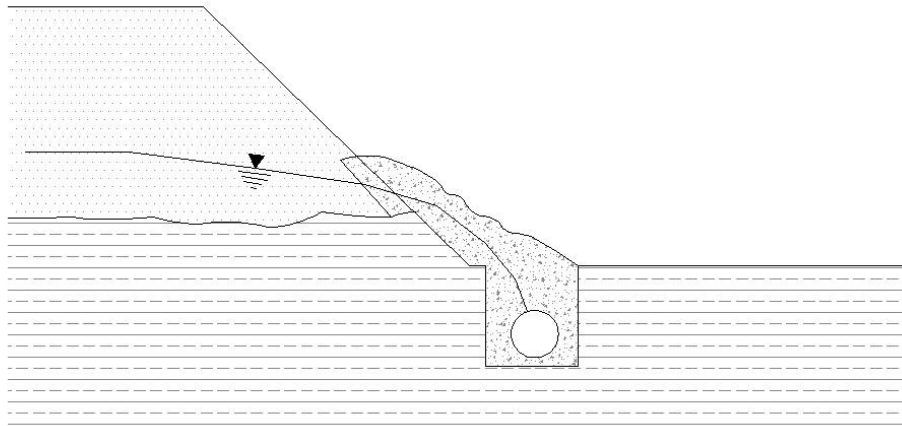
Drenaje general (*Drainage blanket*).
